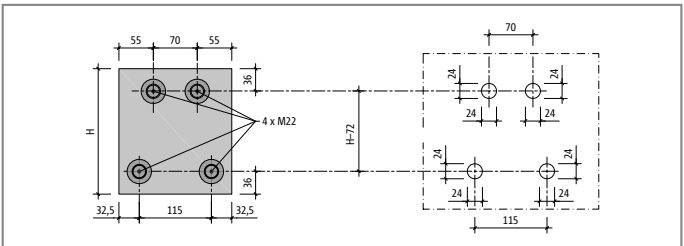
Vorgängertyp Schöck Isokorb® T Typ SK-MM2 mit Betondeckung CV26: Lochbild für die Schalungshilfe
